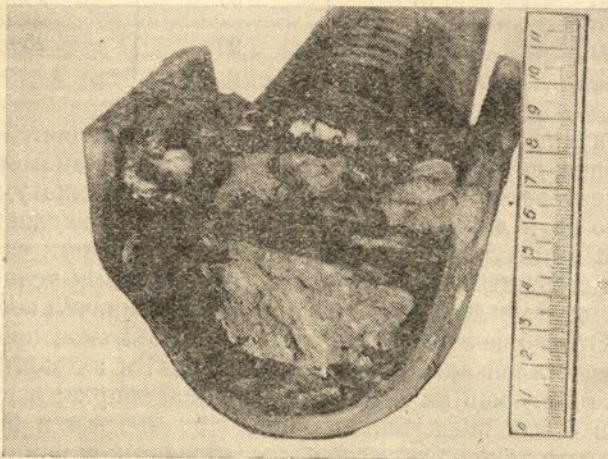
Горизонтальный стык стержней, сваренный ванным способом; разрушение по наплавленному металлу; зашлаковка вызвана перерывом в подаче тока
